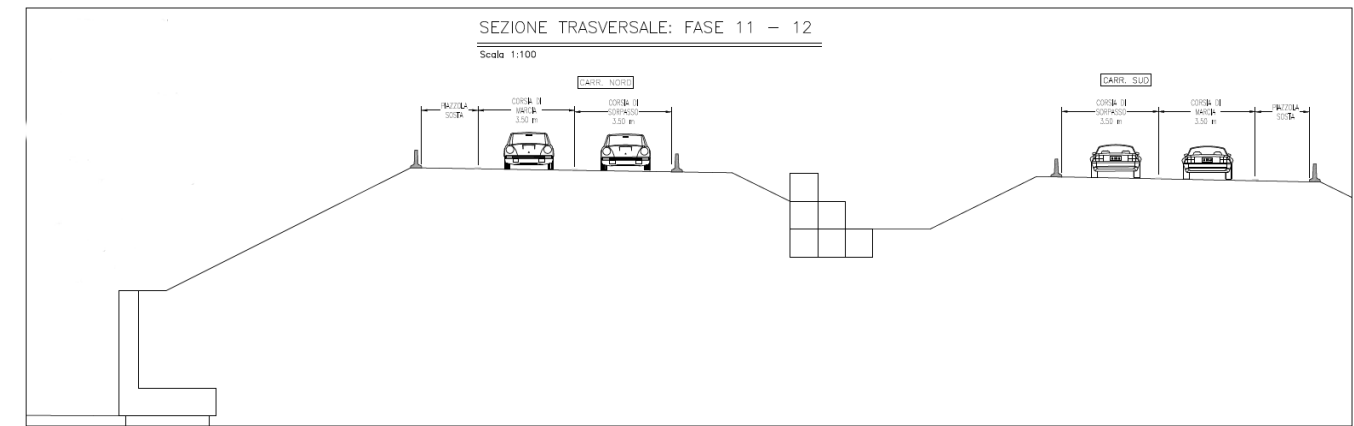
Sezione trasversale: Fasi 11 e 12
